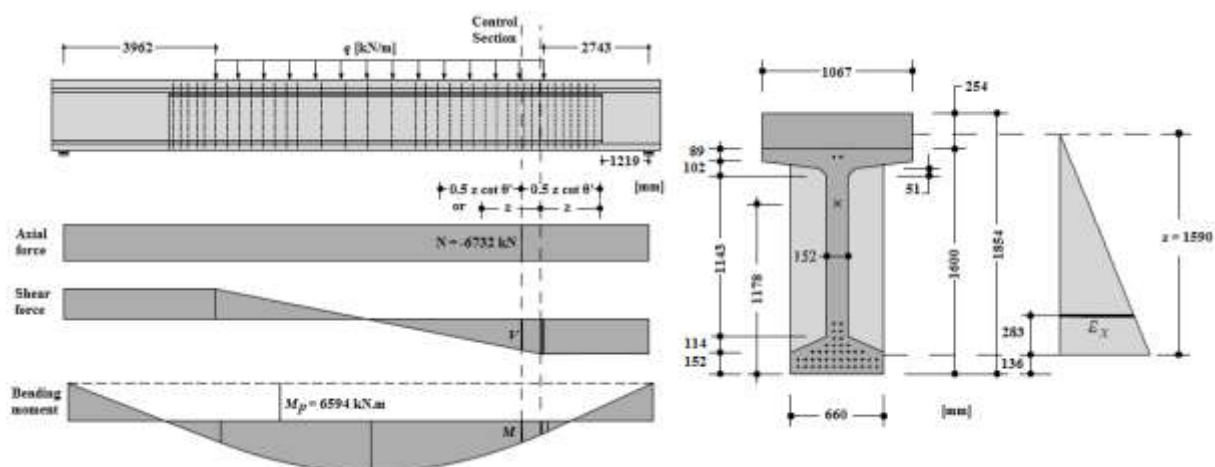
Geometria longitudinal e distribuição dos estribos #4 ($2 \times 129 \text{mm}^2$), secção transversal, disposição dos 42+2 cordões de pré-esforço e dimensões características da viga G8E testada por Kuchma et al. [23].
